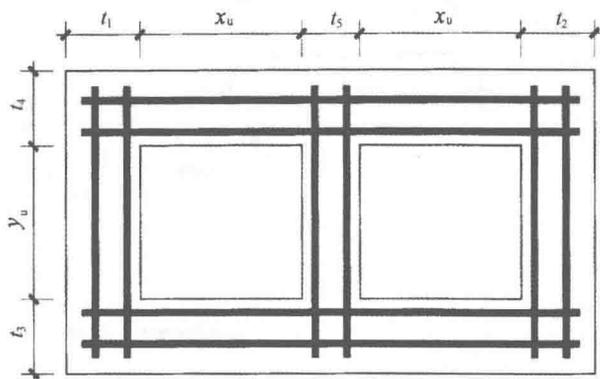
双杯口顶部焊接钢筋网片构造
